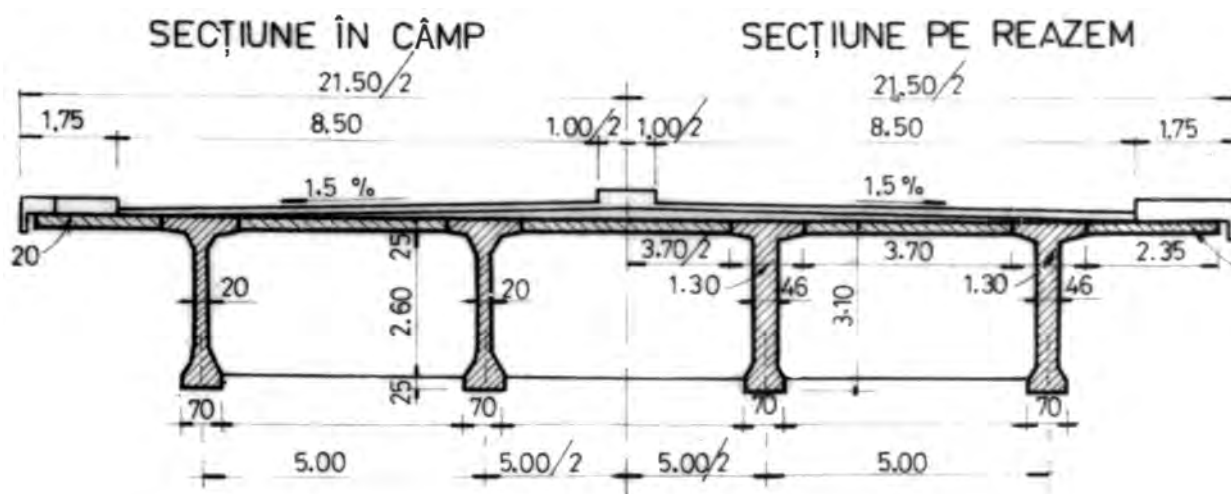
Cadre cu suprastructură mixtă; viaducte de acces
